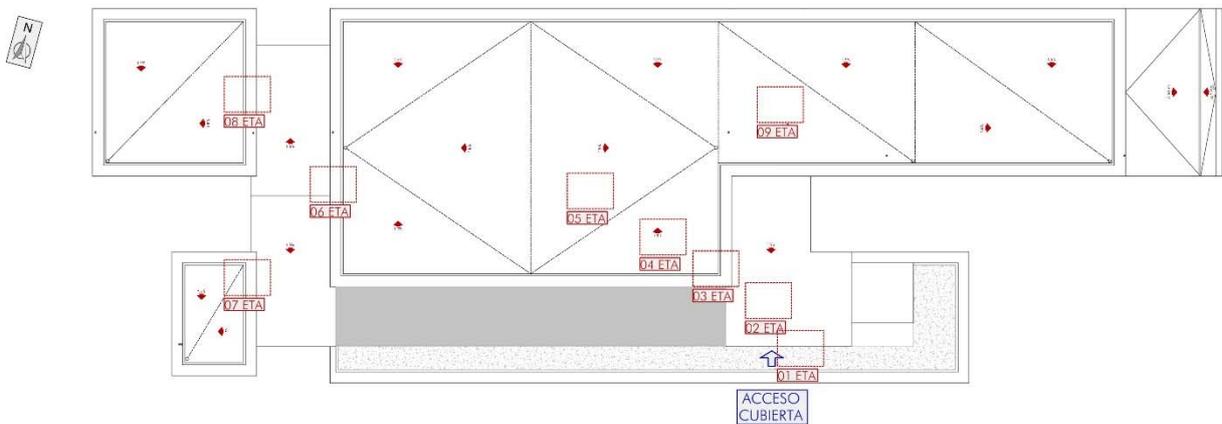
Imagen en la que se aprecian las zonas de obstáculo a la circulación detectados dentro de la cubierta
